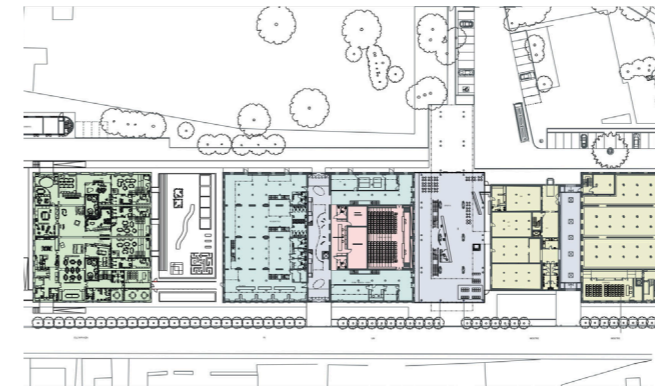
Centro Internazionale Loris Malaguzzi - floorplan
